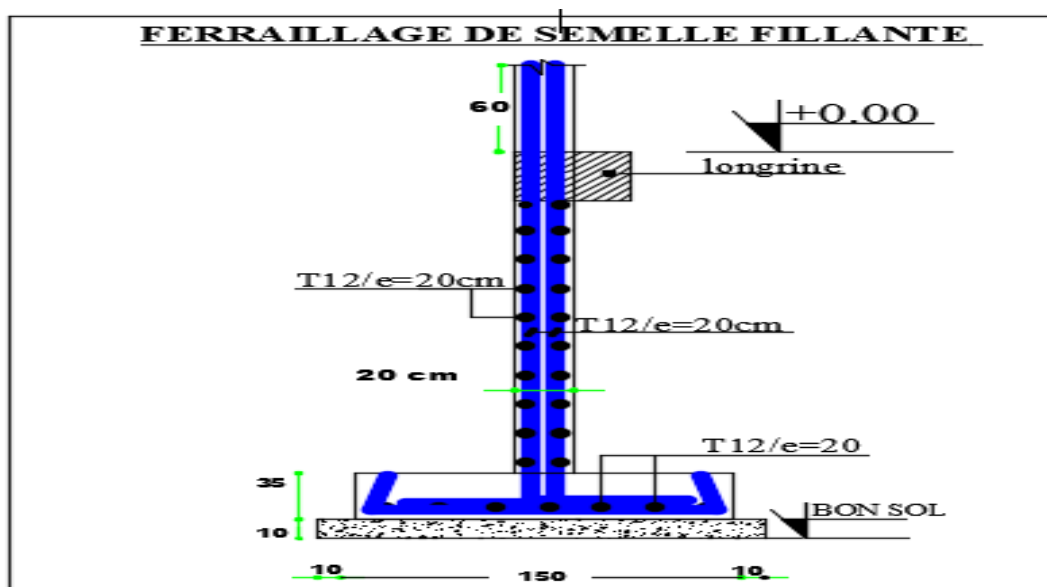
Schéma des Ferrailage de la semelle filante.
